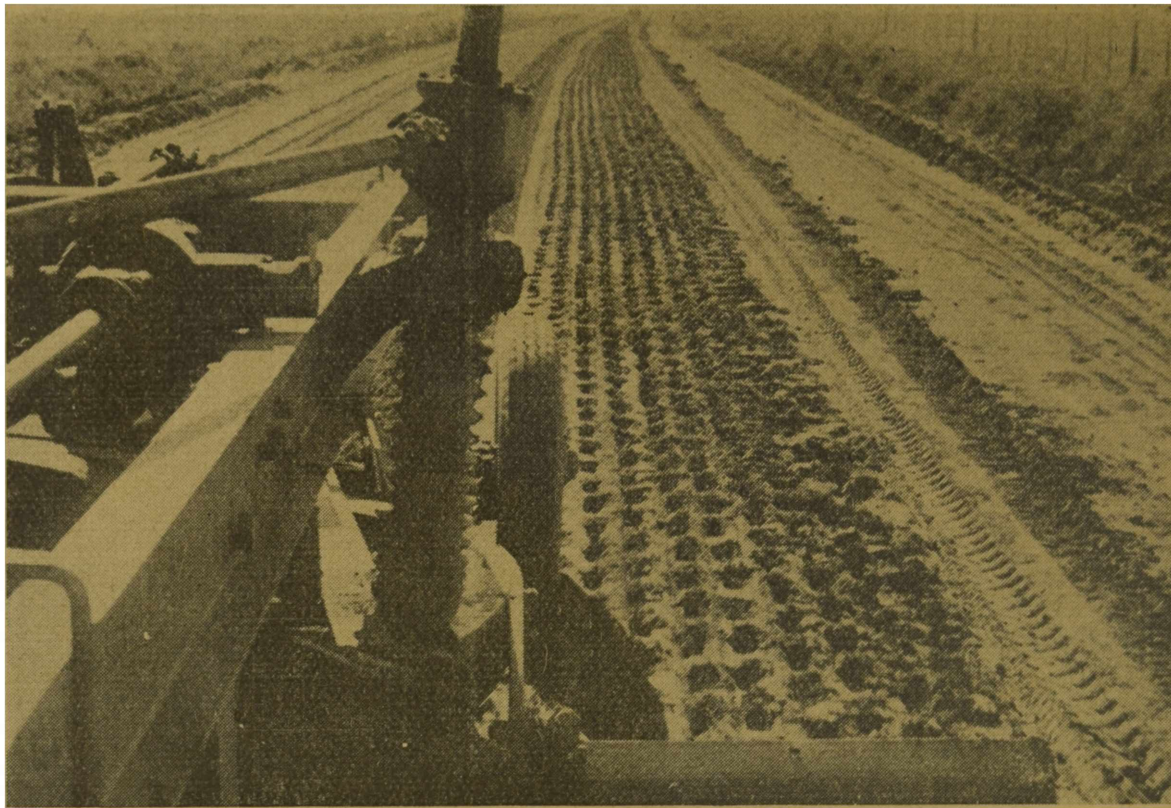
Efectos del rodillo pata de cabra al iniciar la compactación.
